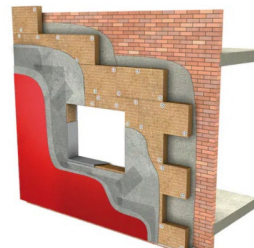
Tipología de fachada tipo II: Fachada SATE (FS)
